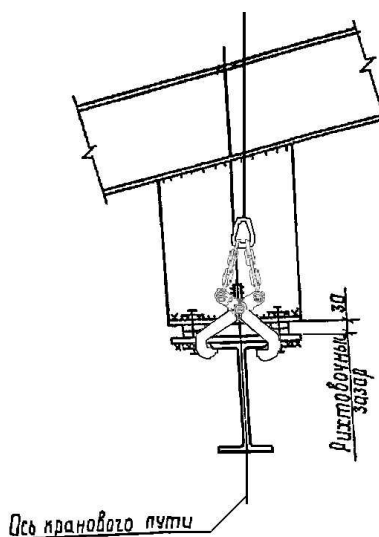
Монтаж подкрановой балки клещевыми грузозахватными приспособлениями.
